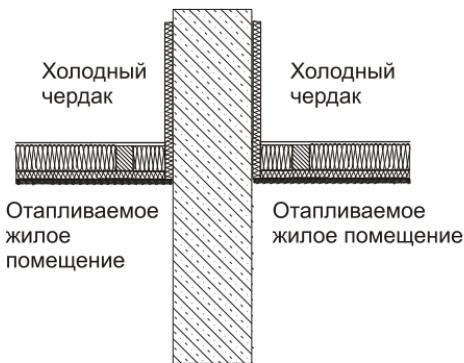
Устранение "теплового мостика" в месте стыка внутренней стены с чердачным перекрытием за счет установки вертикальной внутренней теплоизоляции в чердачном помещении
